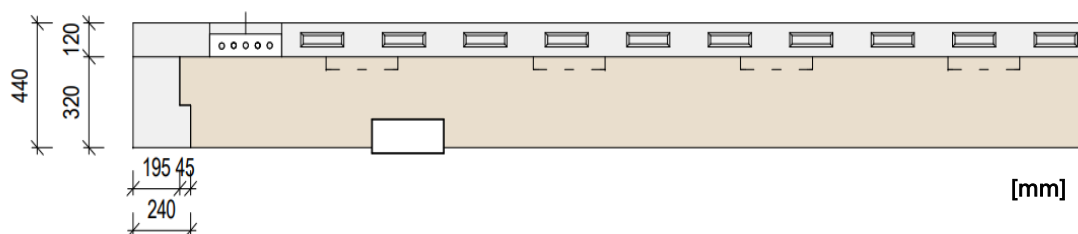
Corte C-C da laje mista corrente, fecho de bordo exterior (sem escala)
